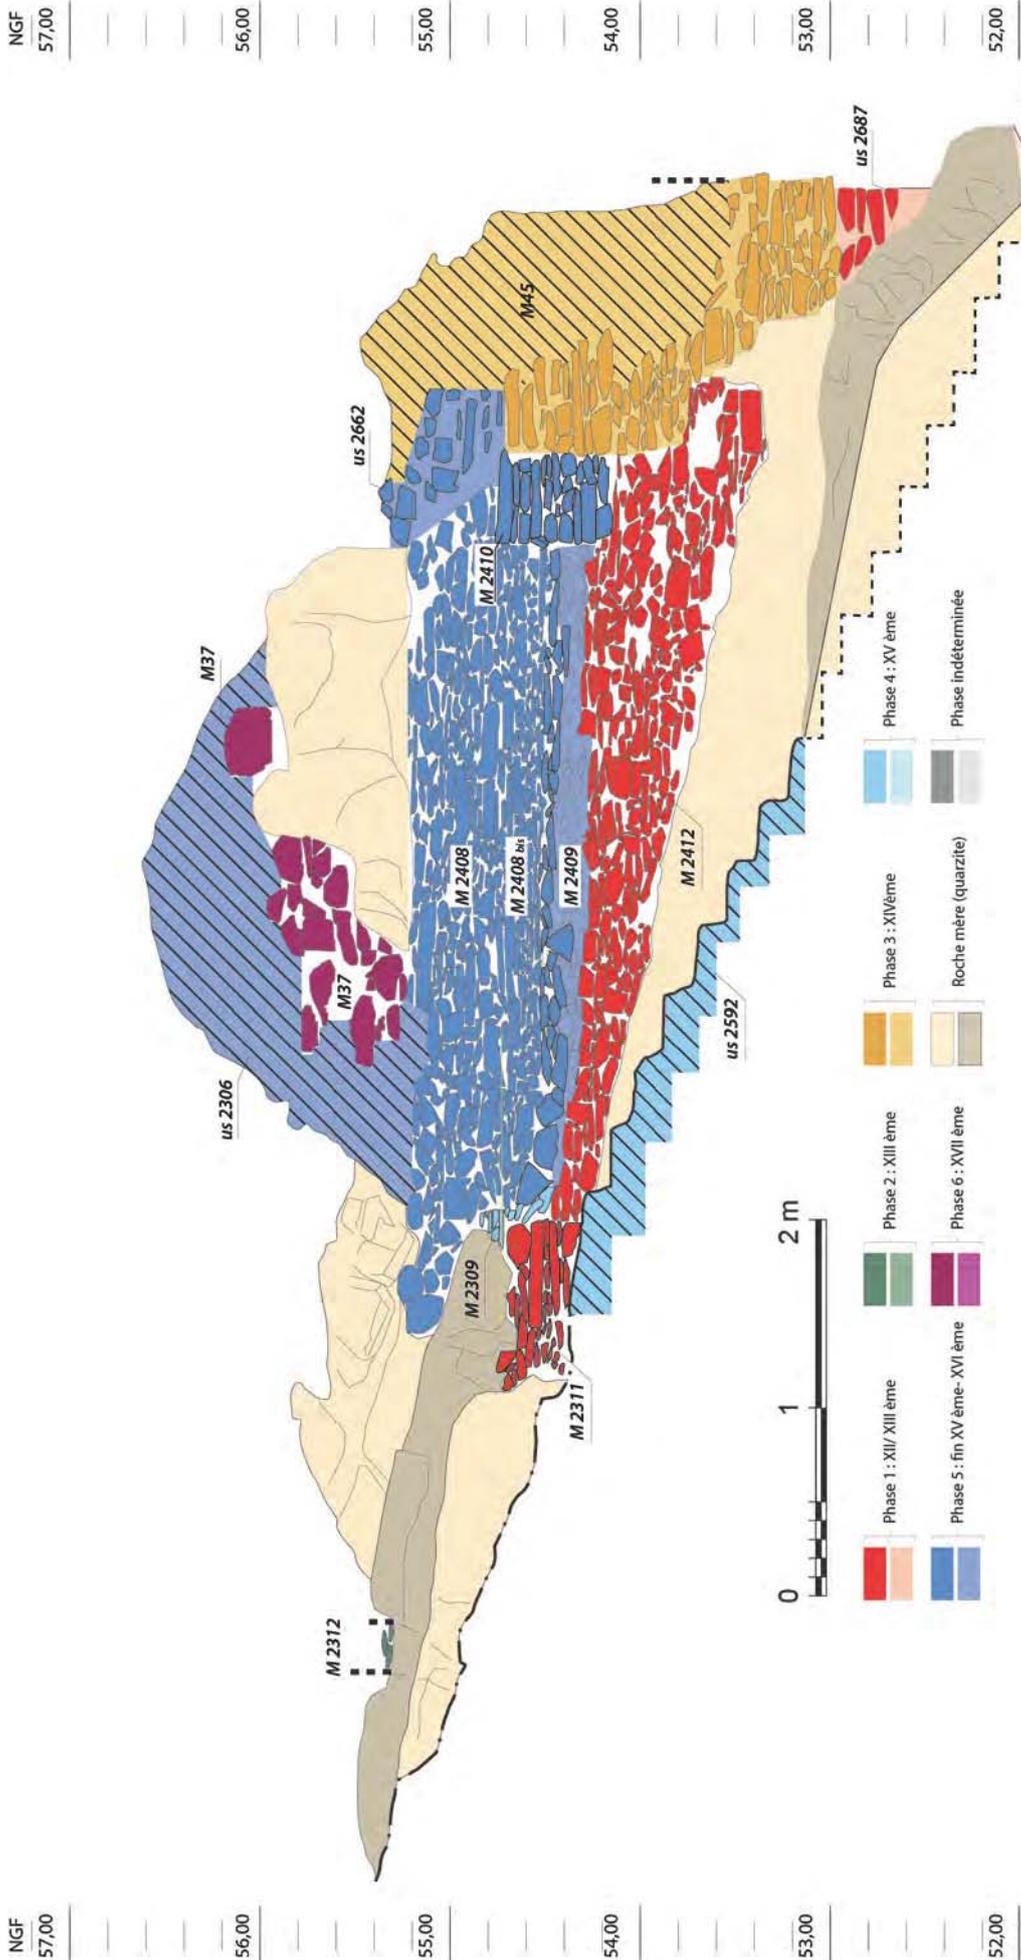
Élévation nord des murs M 2412, M 2311, M 2408, M 2410, M 45, M 37.
